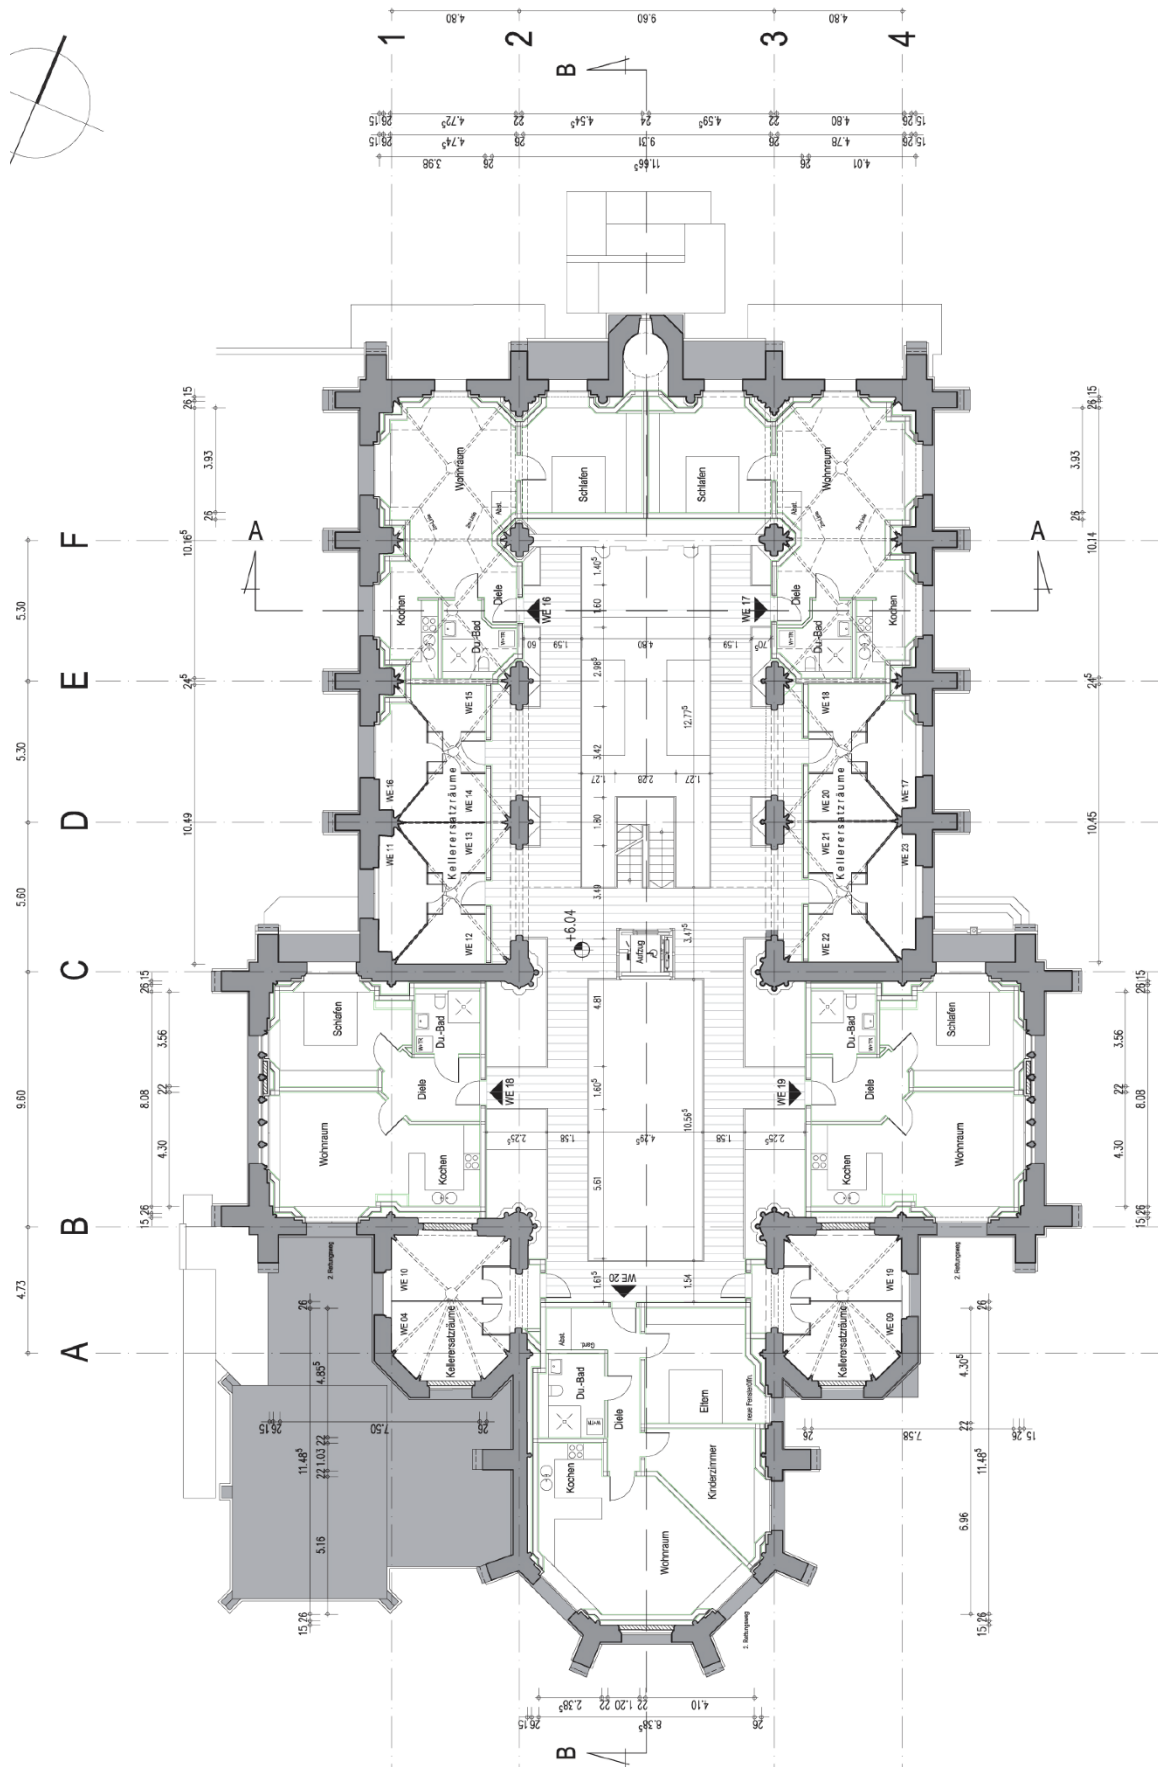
Grundriss 2. Obergeschoss
